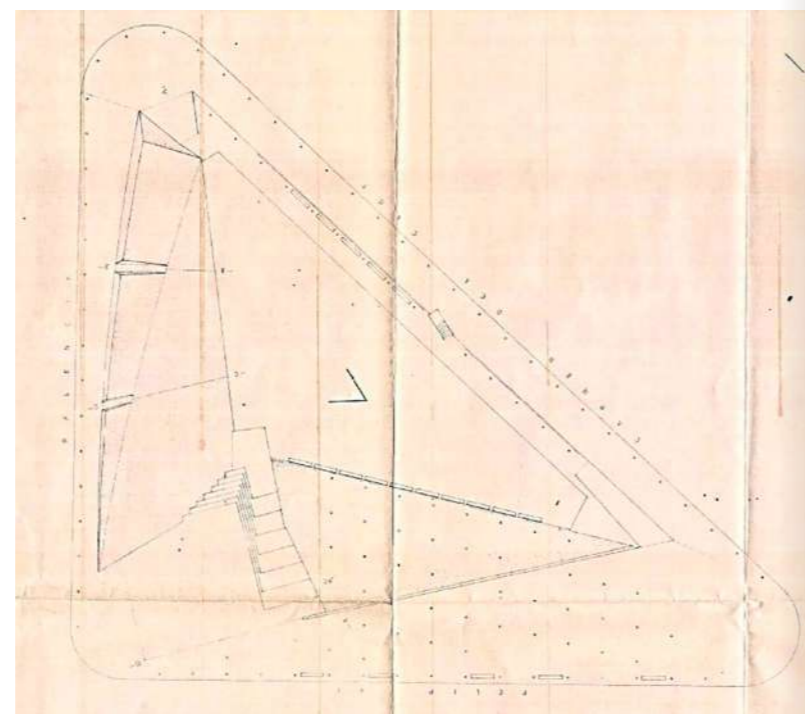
Planta emplazamiento de escultura. Fuente Archivo Municipal Contemporáneo.
